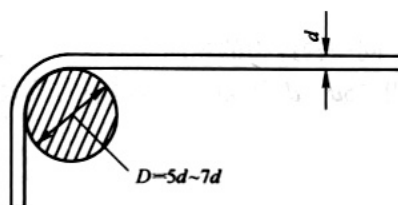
F416022-7 HRB335、HRB400 钢筋弯转 90° 示意图
